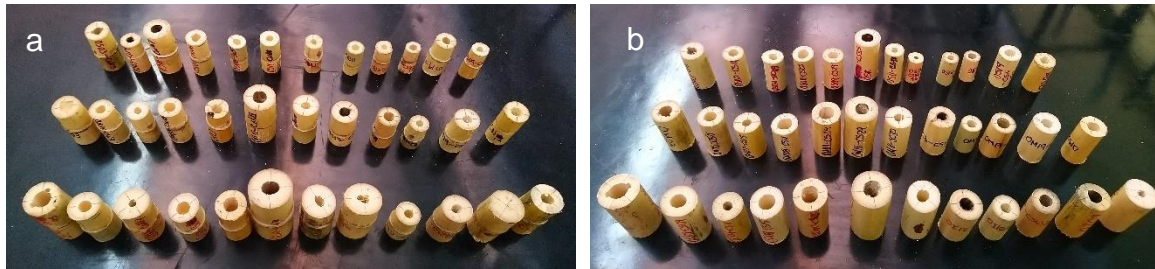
Probetas para ensayos a compresión a) con nudo b) sin nudo.
